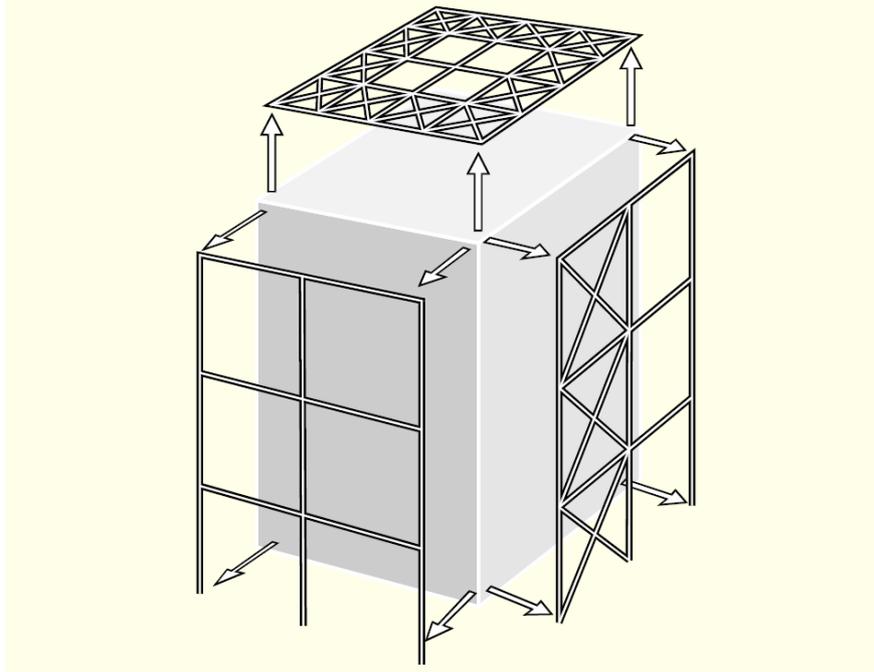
Contraventamento planos conjuntos com resultante espacial [4]
